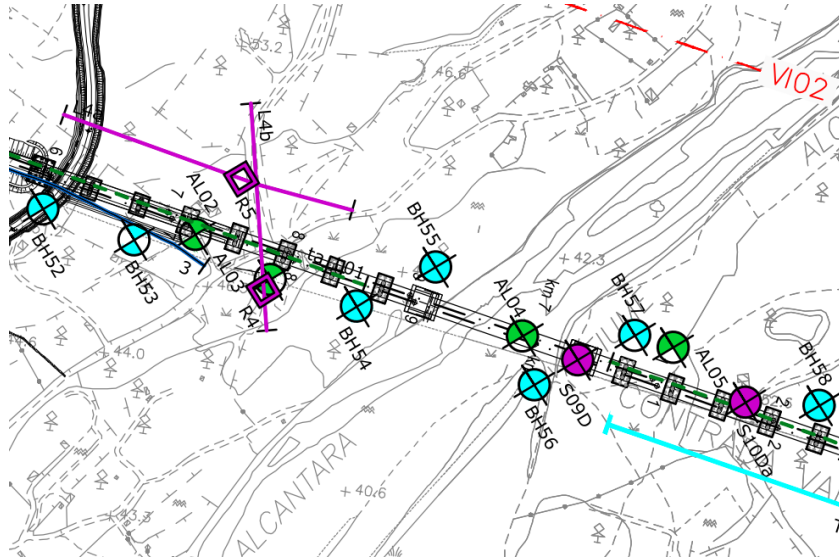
Stralcio della planimetria con ubicazione dei sondaggi da BH52 a BH58
